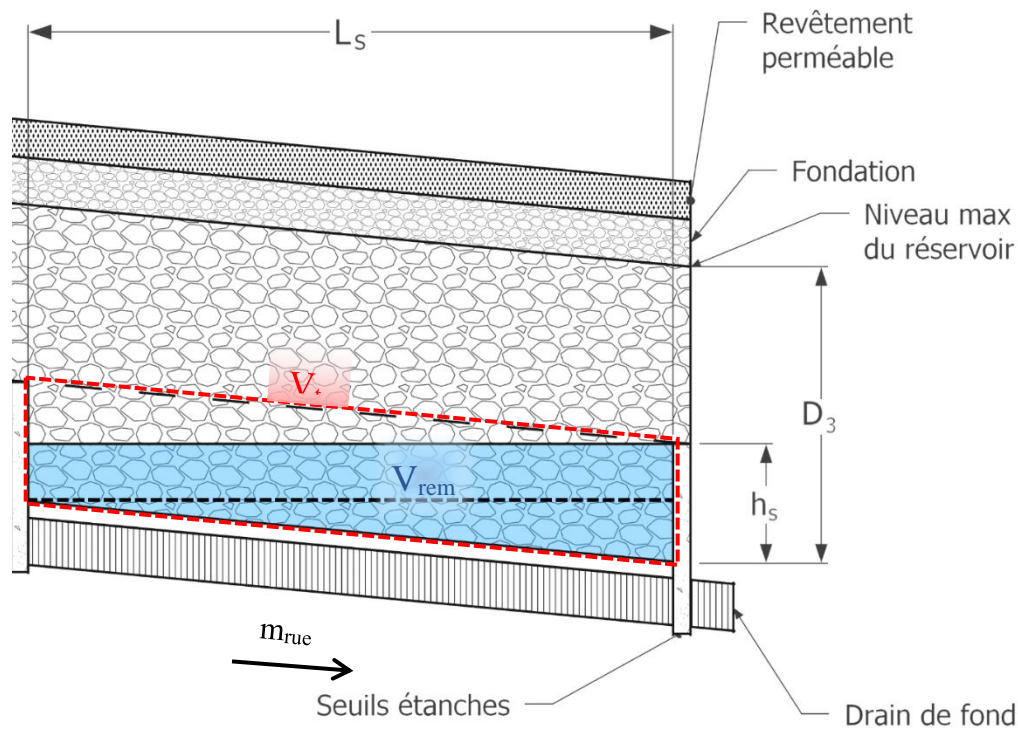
Coupe longitudinale d'un RG entre deux seuils au droit du drain de fond
